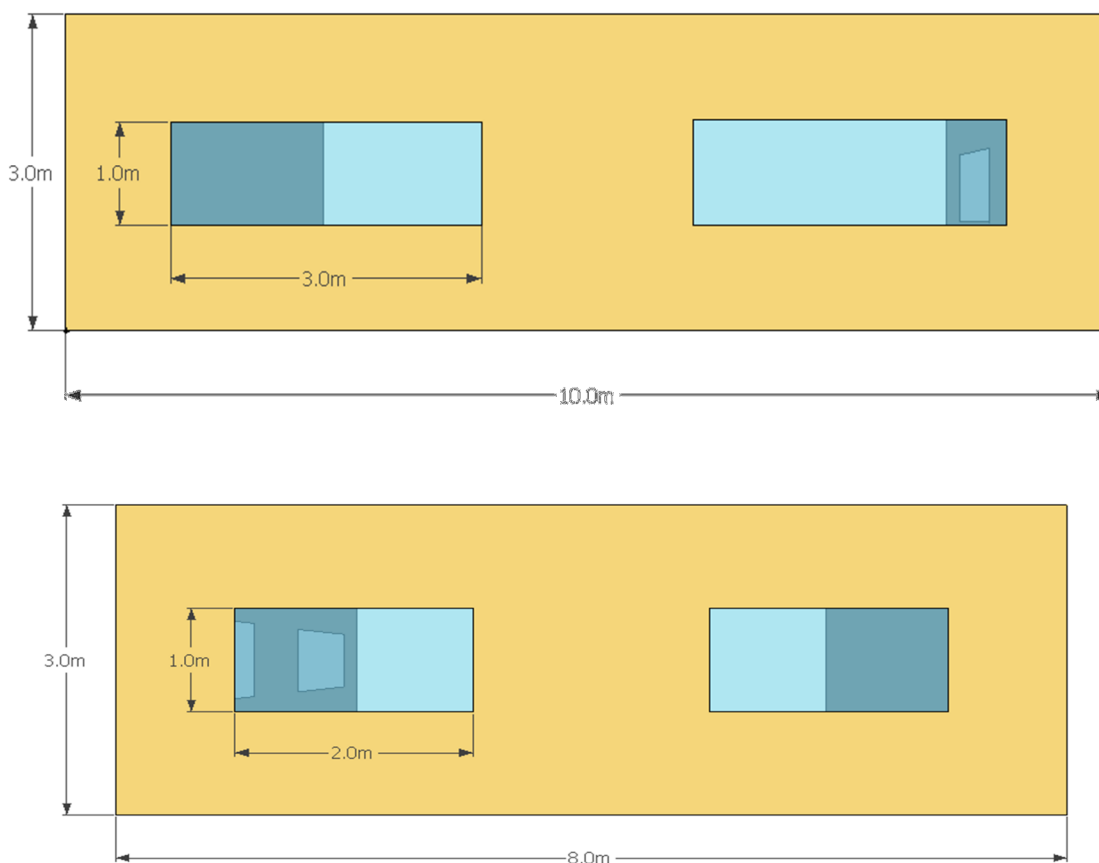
Vistas das fachadas Sul(em cima) e Este(em baixo) da casa modelo
